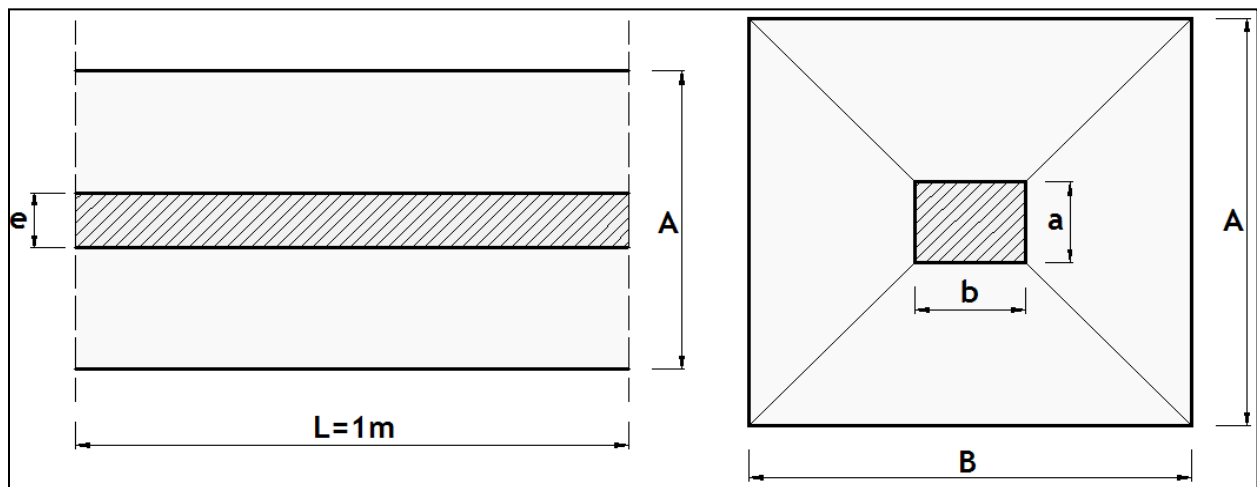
Semelles isolées sous poteaux et continues sous voiles.
